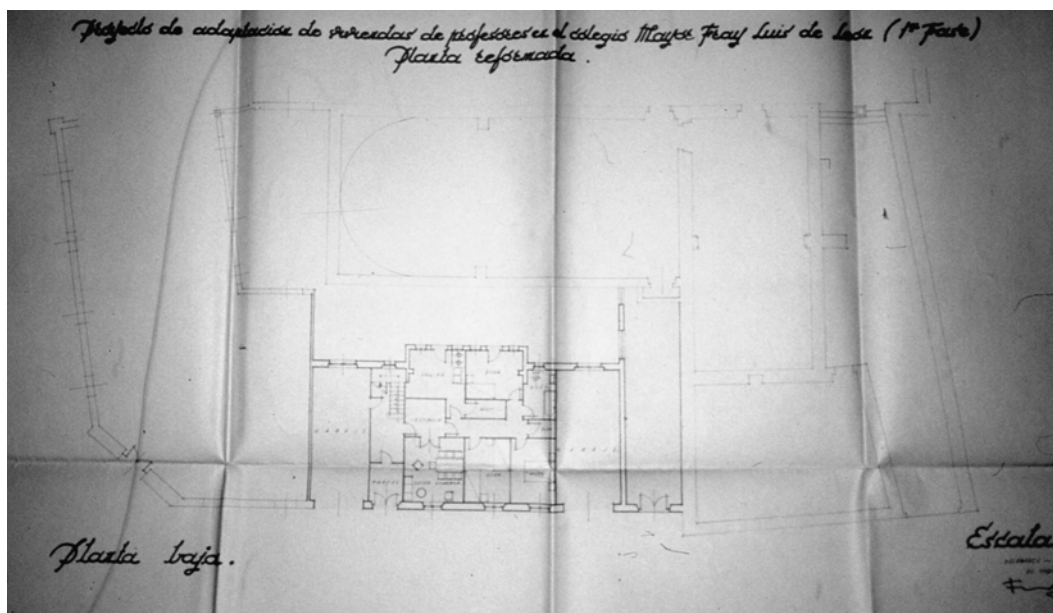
y 243. C. M. Fray Luis de León: ampliación de planta baja y primera, estado en 1957.
